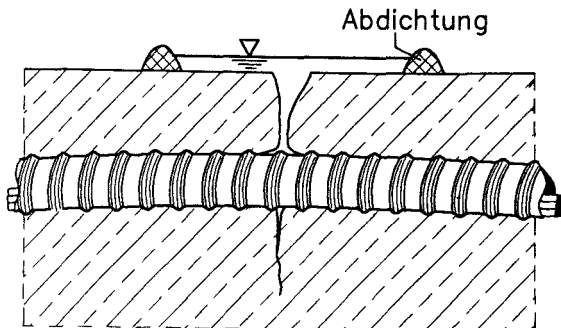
Örtliche Wasserbeaufschlagung eines Betonrisses während der dynamischen Beanspruchung
